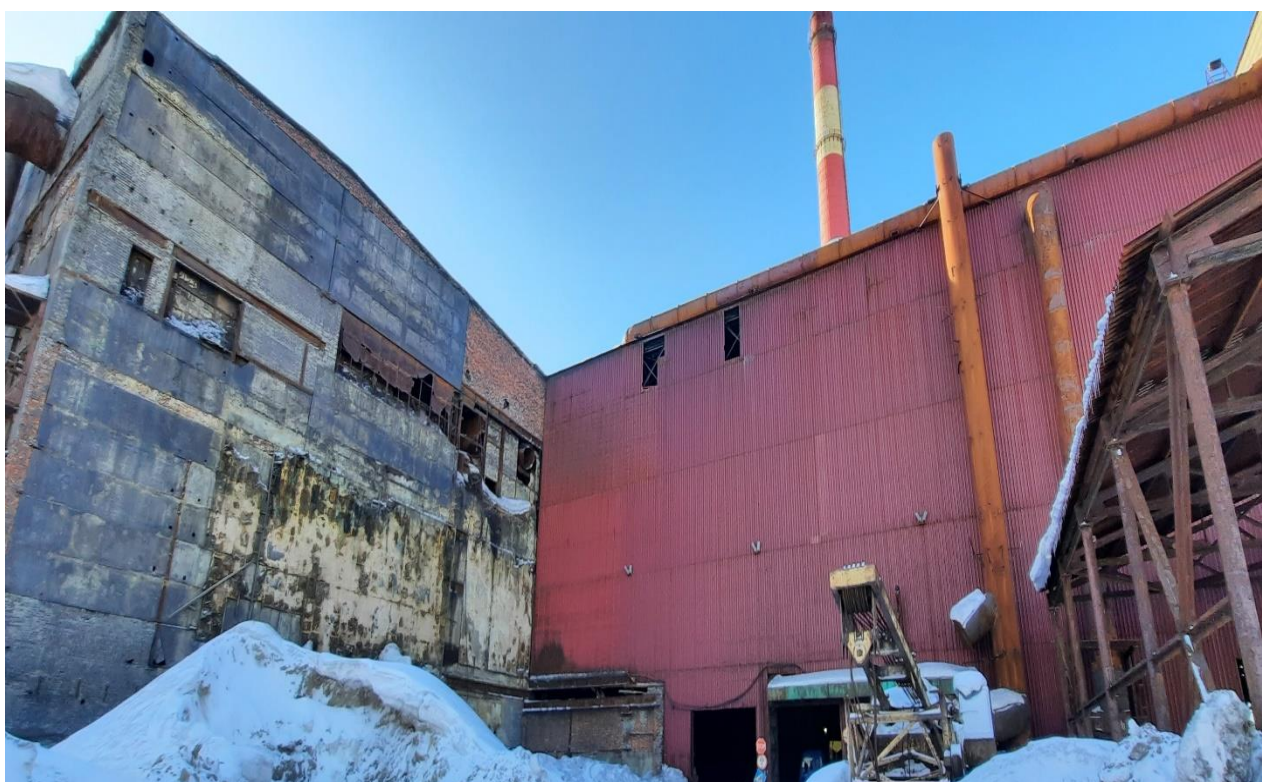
Фрагмент фасада здания в осях: К-Р/59
